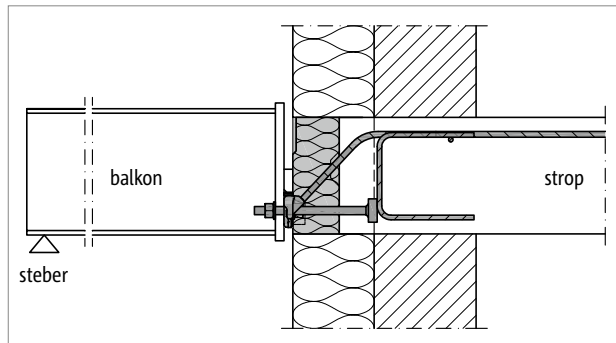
Schöck Isokorb® T tip SQP-WU: posebna konstrukcija, potrebna pri priključku na železobetonsko steno
